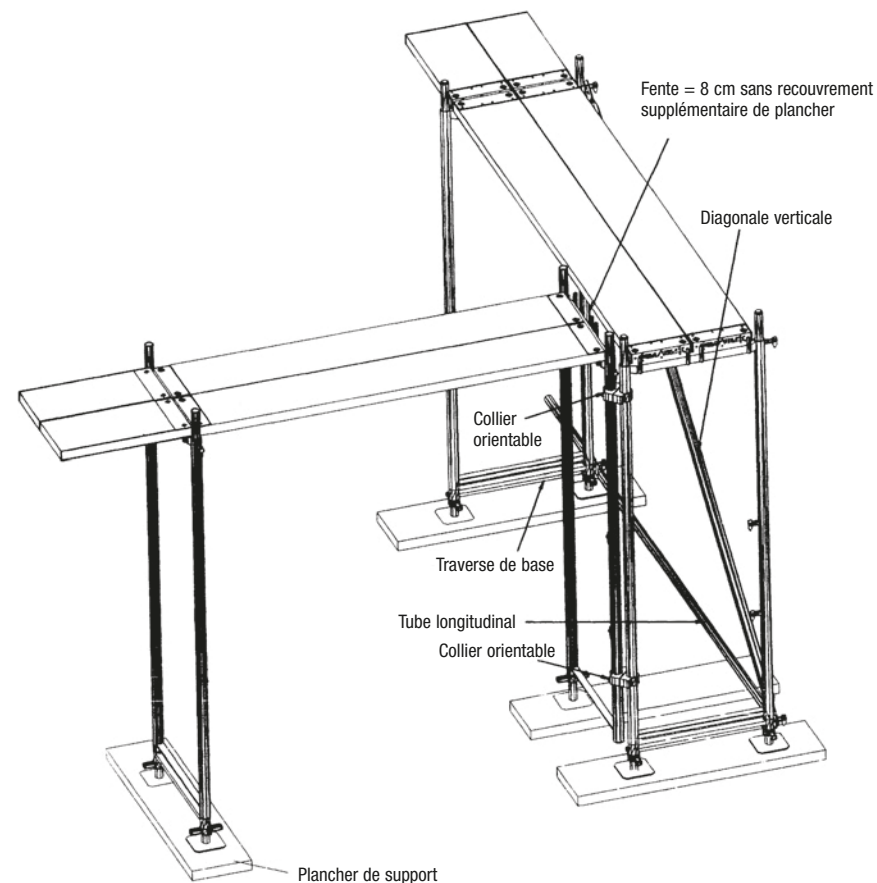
Construction en angle par assemblage à l'aide de colliers orientables
